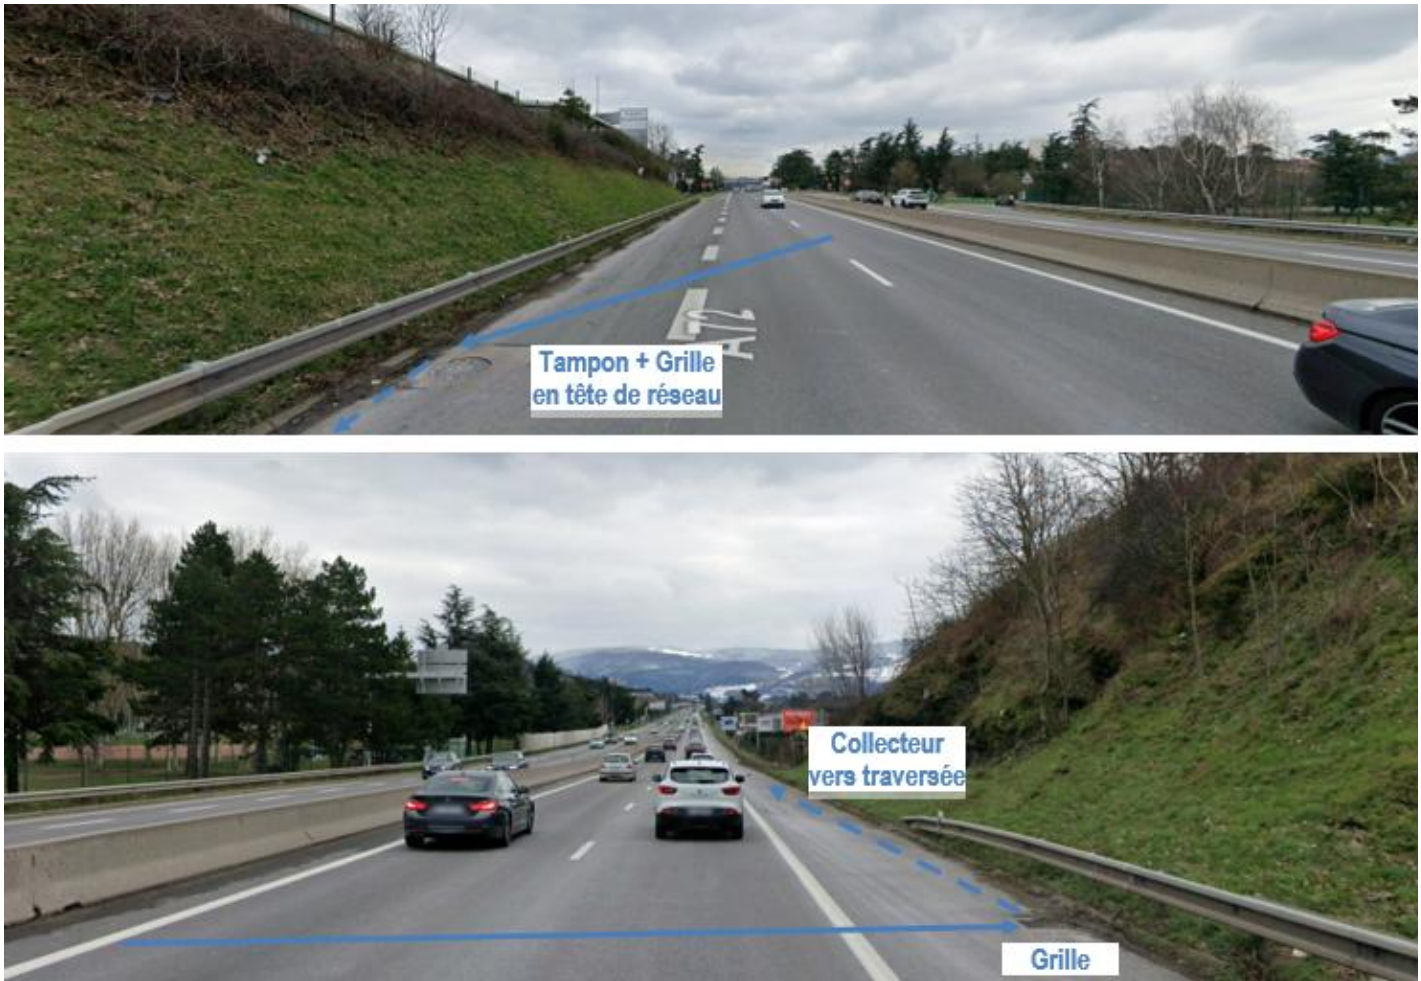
Tampon et grille en bord de chaussée du sens 2
